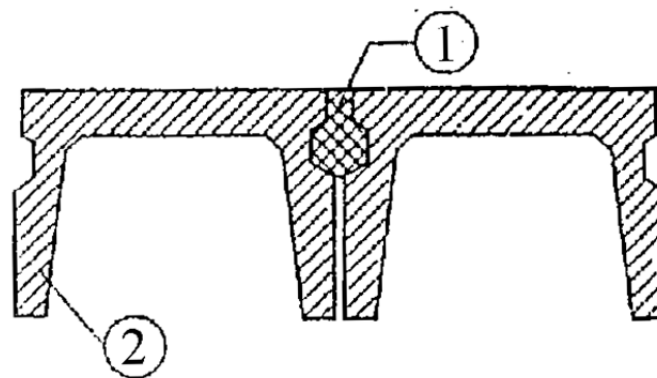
Plattenbalken – Fertigteilkonstruktion (1) Verdübelung aus Ortbeton, (2) Fertigteilelement
